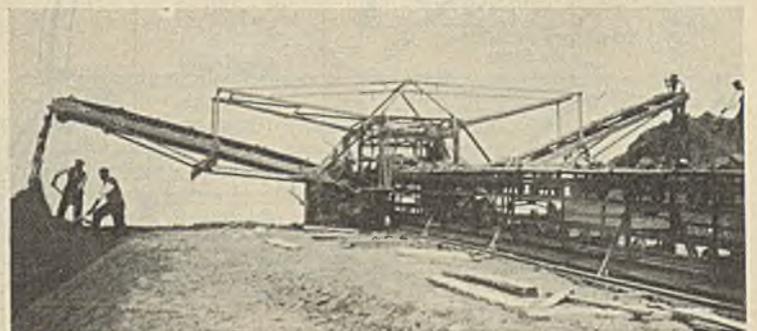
Abwurfwagen mit seitlichen Förderbändern zum Anschütten des Damms am Ende der Förderstrecke.
